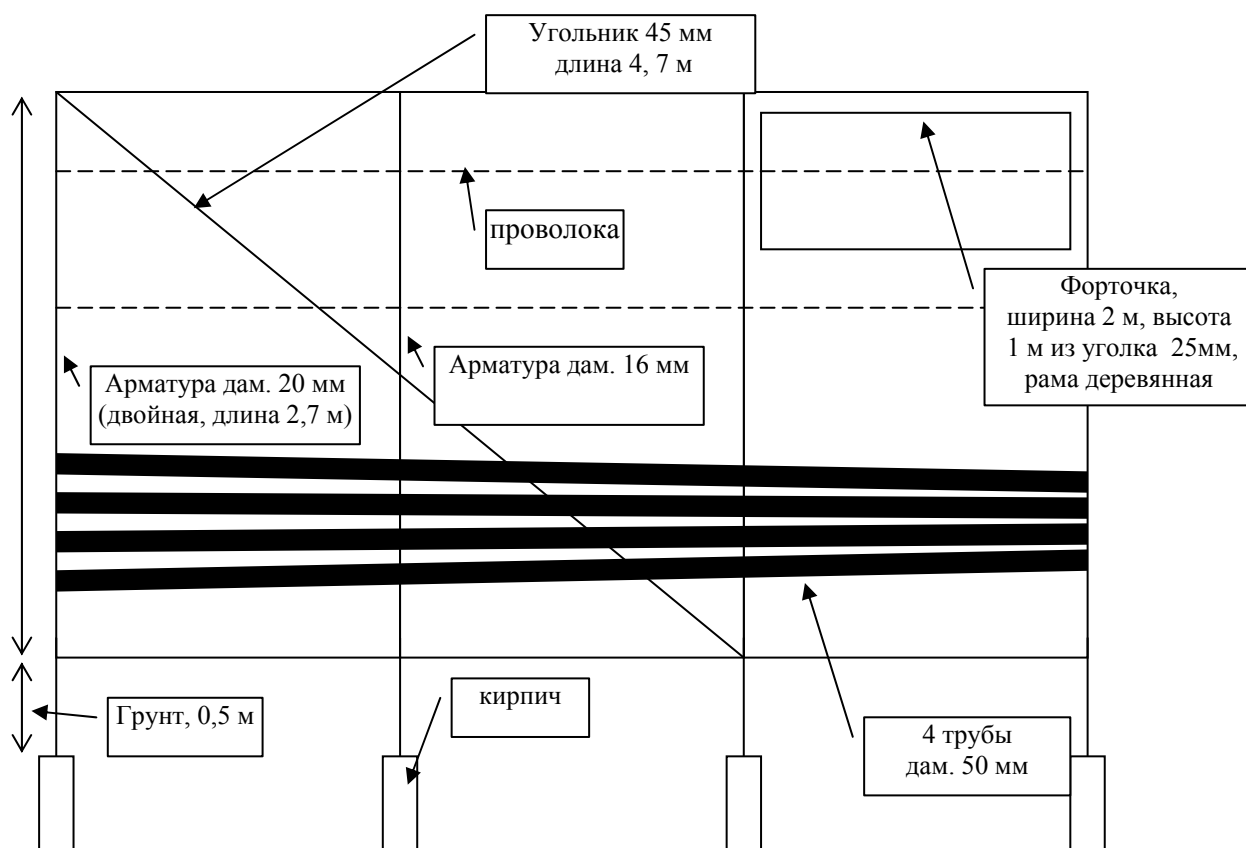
Фрагмент продольной стенки индивидуальной пленочной теплицы.
